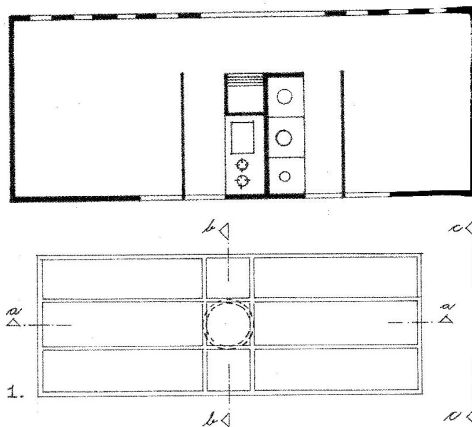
e 12, Acervo NPD, Plantas da Casa e da Estrutura de sua Base.
